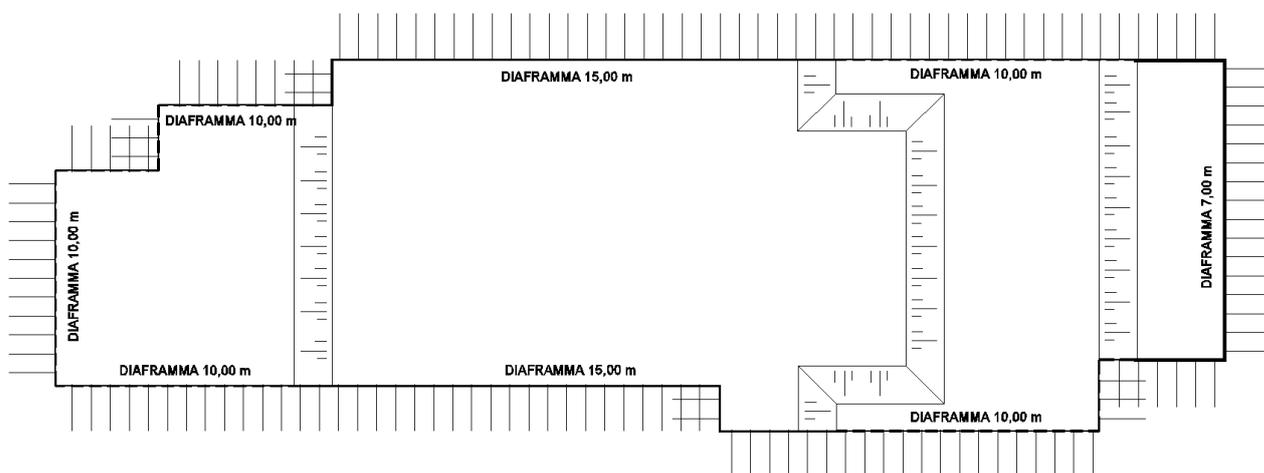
PIANTE SCHEMATICA DEGLI SCAVI
